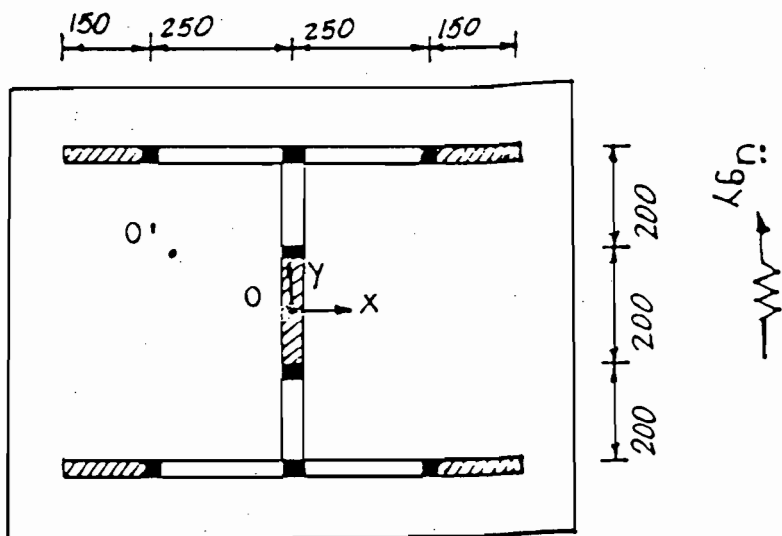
Planta Edificio Estructurado con Muro-Marco.
